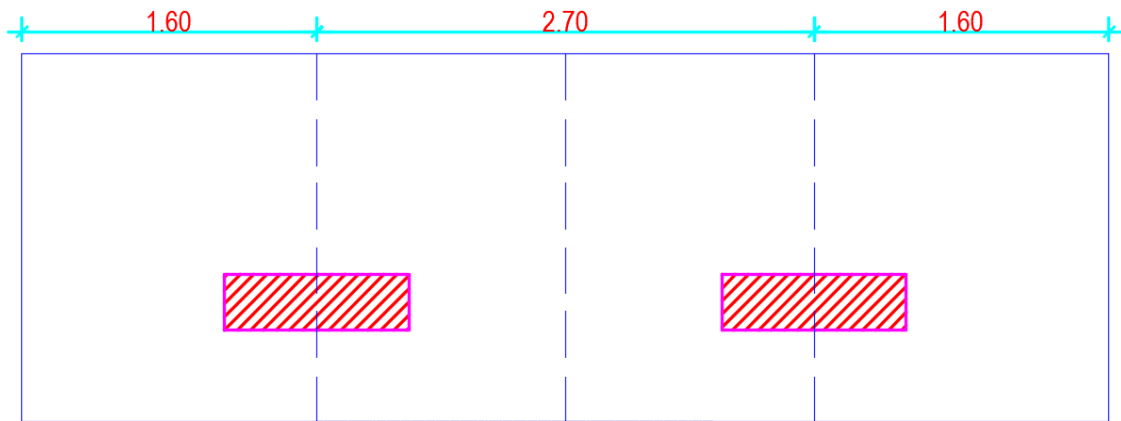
Plano final de la zapata combinada AutoCAD.
